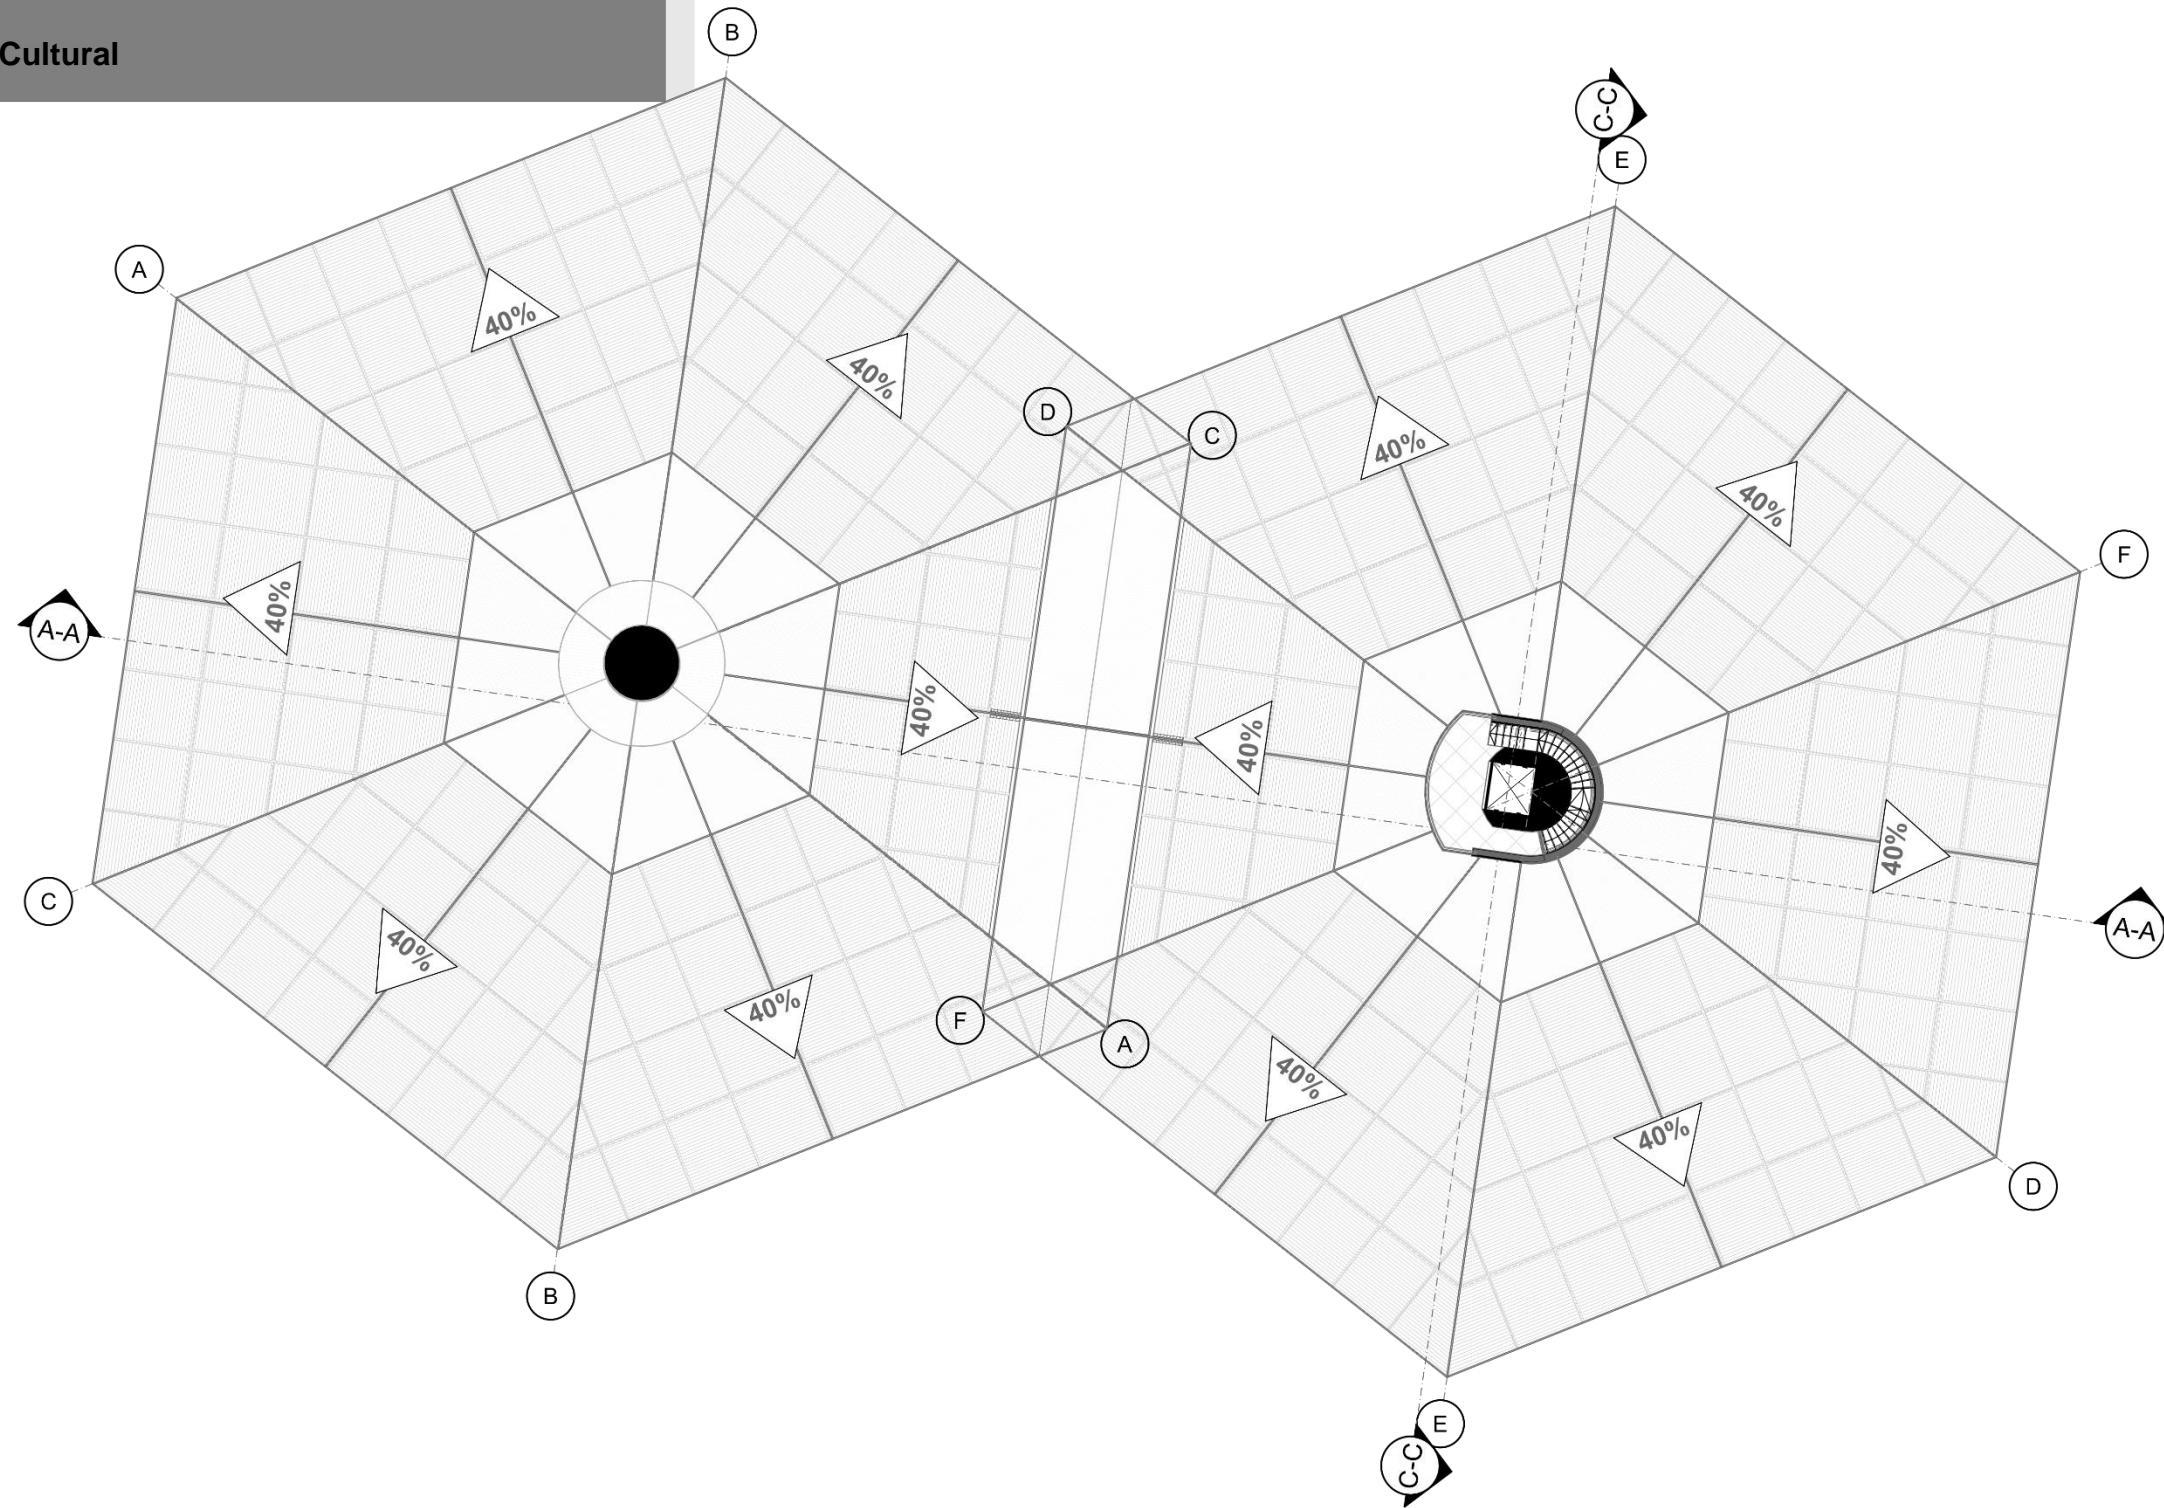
, Planta Arquitectónica de Cubierta Edificio Cultural, Propiedad Personal, Tomada 2023
